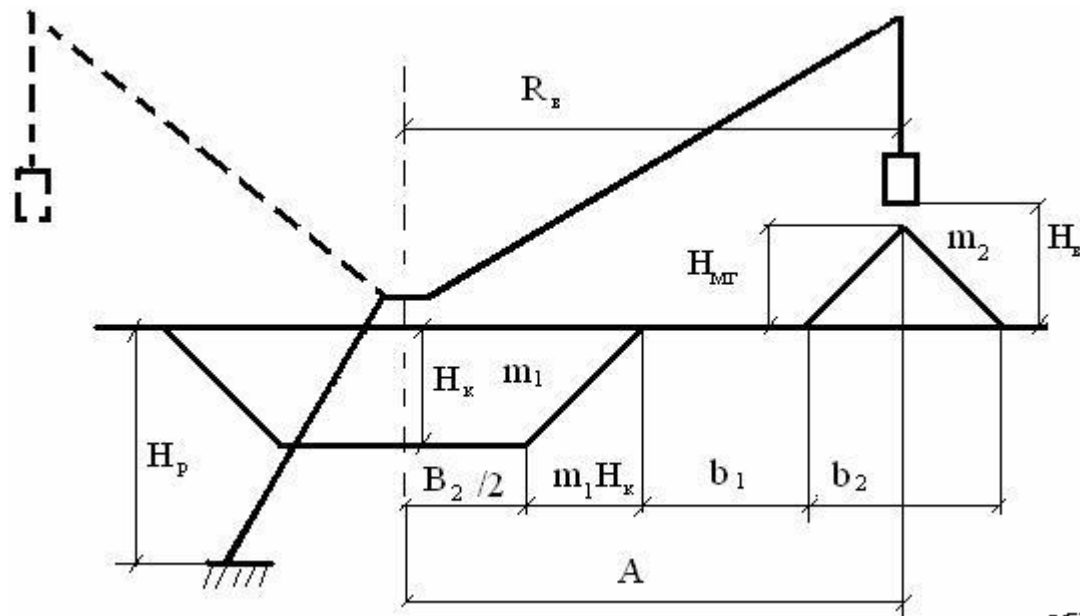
Схема продольной разработки грунта в котловане НС
